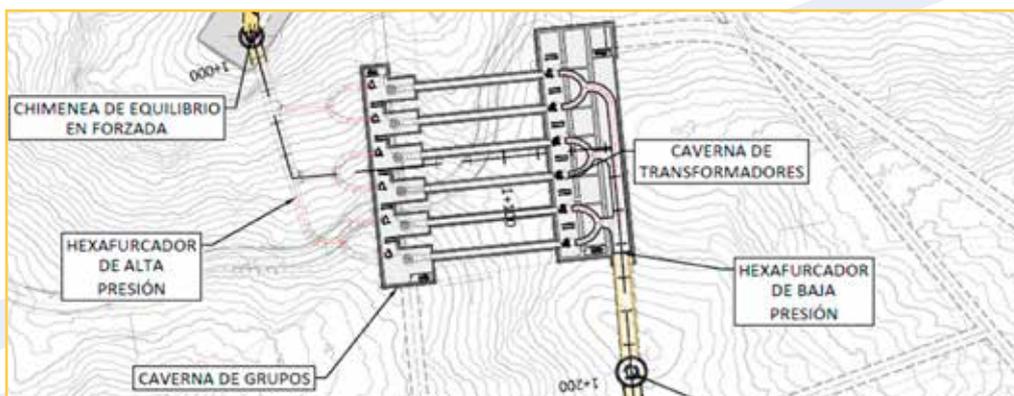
Hexafurcadores de alta y baja presión. Fuente: Proyecto Modificado I – REE.
